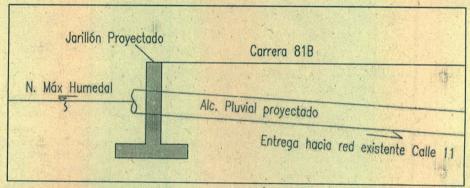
Esquema del jarillón y tubería de rebose que entregaría a las redes proyectadas de Alcantarillado Pluvial que posteriormente entregaría a redes existentes a la altura de la calle 11 con Cra. 81B.
